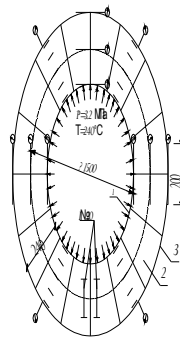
Конструкція дослідного сталобетонного кільця з подвійним полосовим армуванням та схемою завантаження: 1 – внутрішня полоса (товщина 3-4 мм); 2 – бетонне ядро; 3 – зовнішня полоса завтовшки 5-7 мм.
